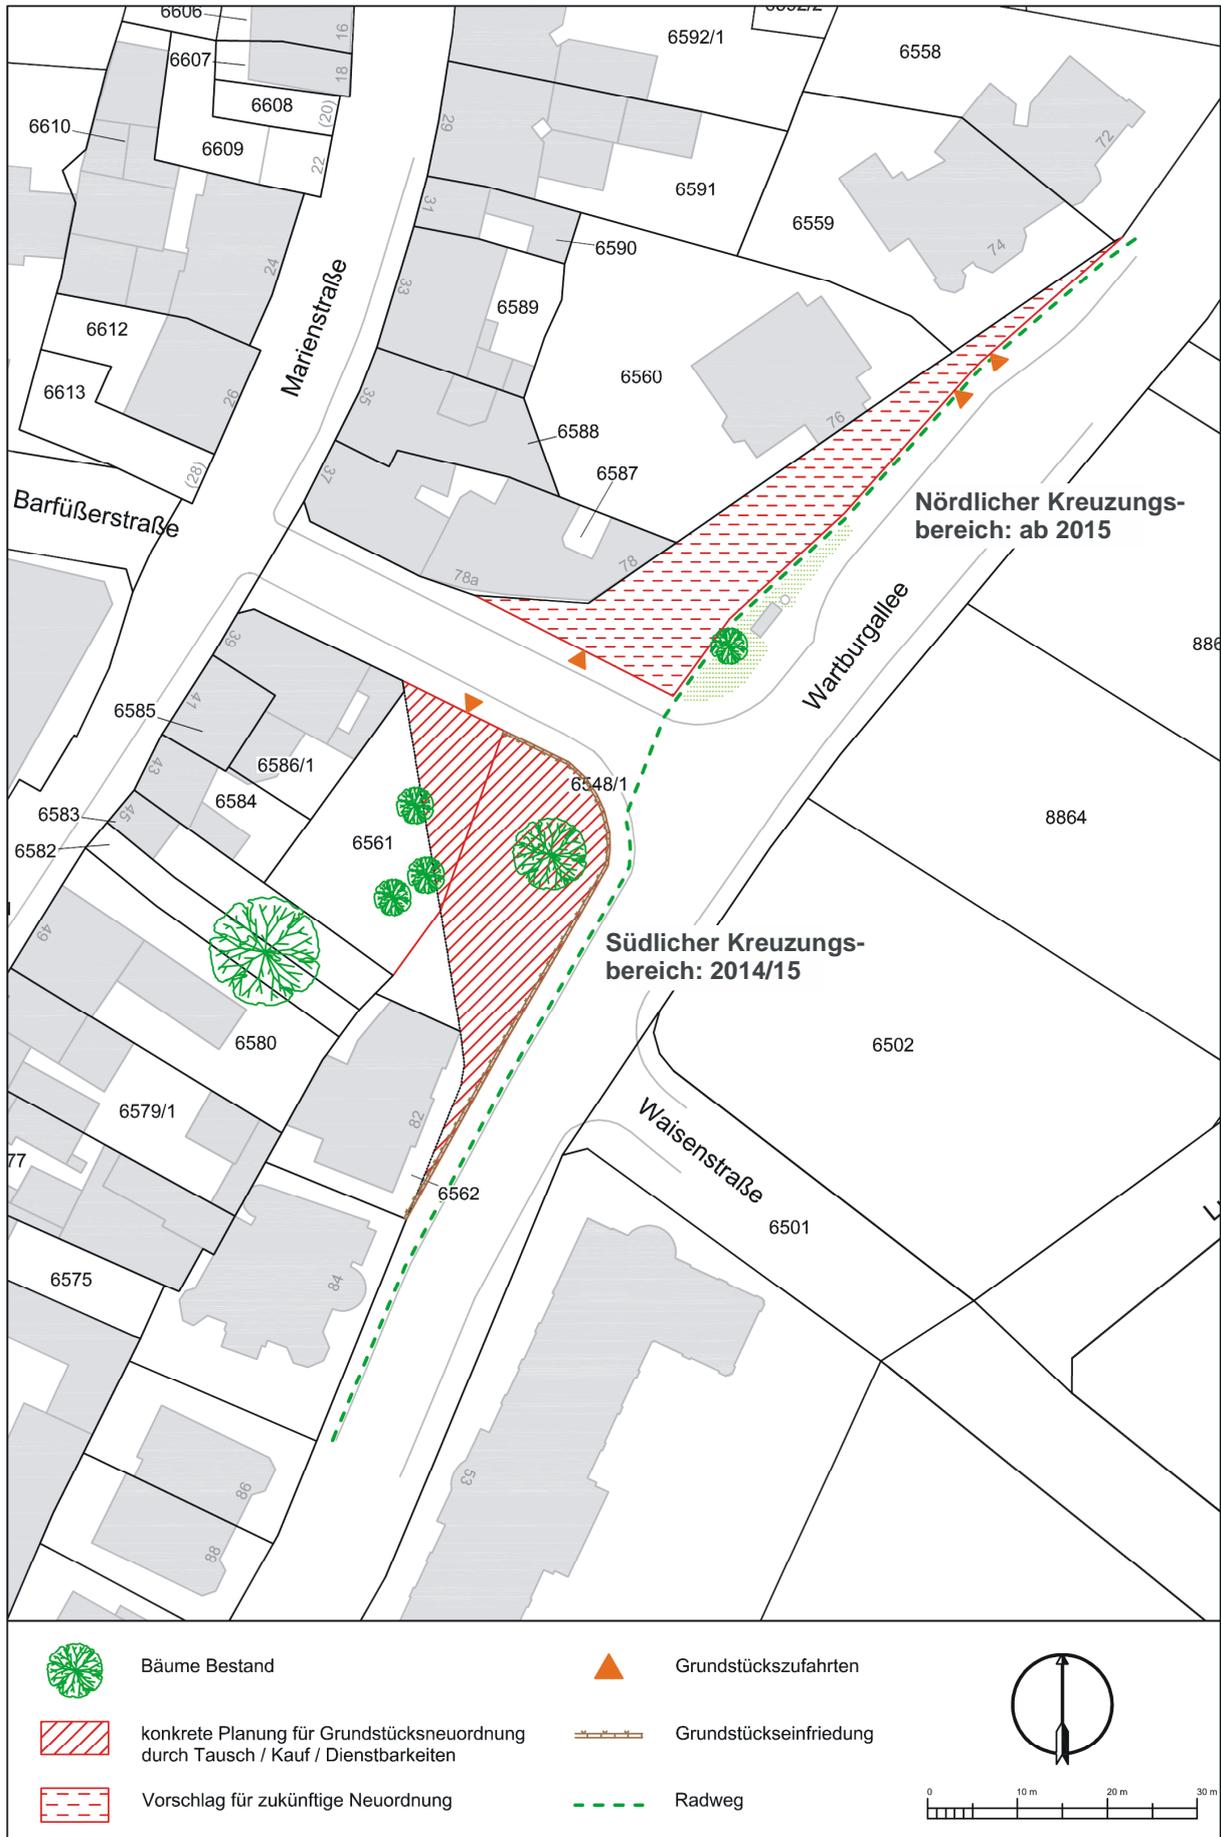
Bodenordnung für den Kreuzungsbereich Wartburgallee - Barfüßerstraße
